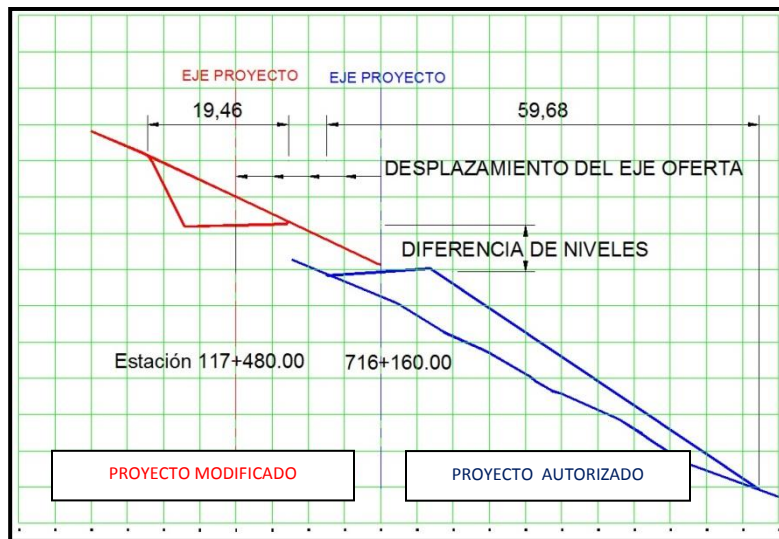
Mejora de sección proyecto autorizado - sección proyecto modificado (km 117+480.00)
